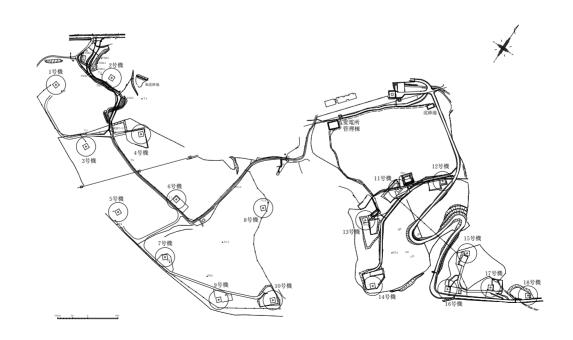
岩屋ウィンドパーク配置図 Fig. 2 Layout of Iwaya Wind Park
